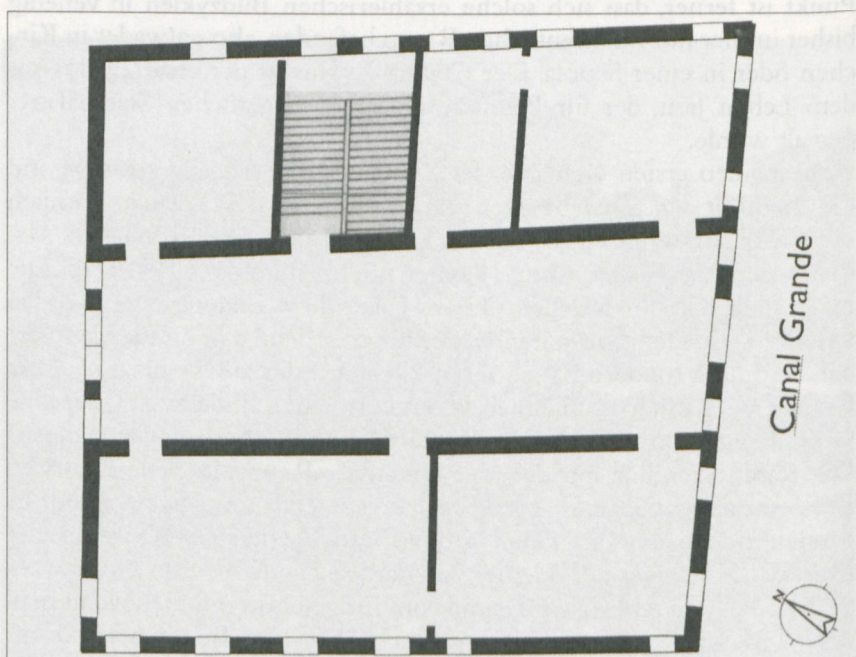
Grundrissrekonstruktion des Portego im ersten Obergeschoss des Palazzo Cucina
